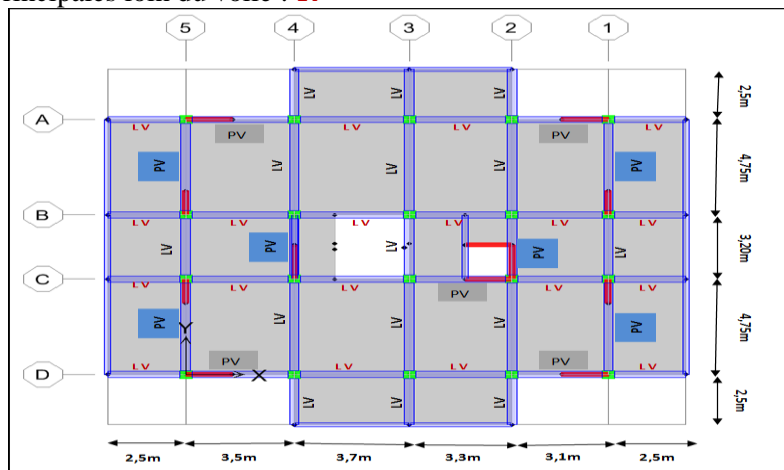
Disposition des poutres principales et secondaires proche et loin des voiles.
